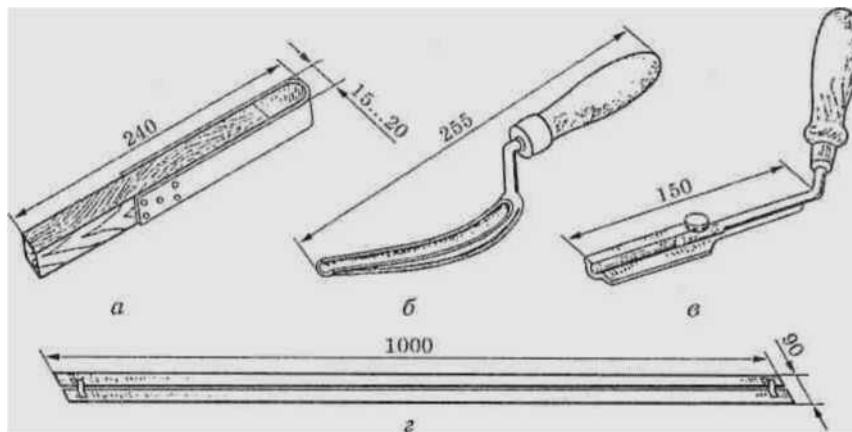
Інструменти і пристрої для виконання рустів: а— рустовка; б— розшивка; в — розшивка зі змінними лезами; г— лінійка
